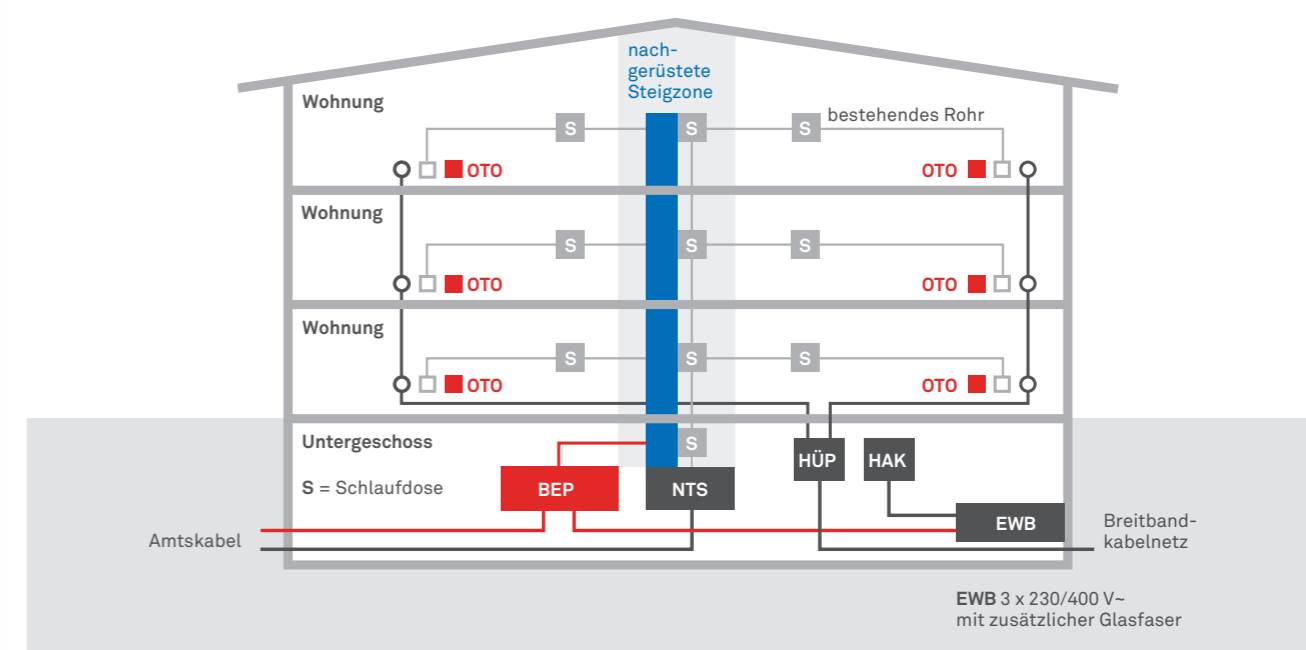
MFH-Altbau mit nachgerüsteter Steigzone (Aufputz-Steigleitung)
